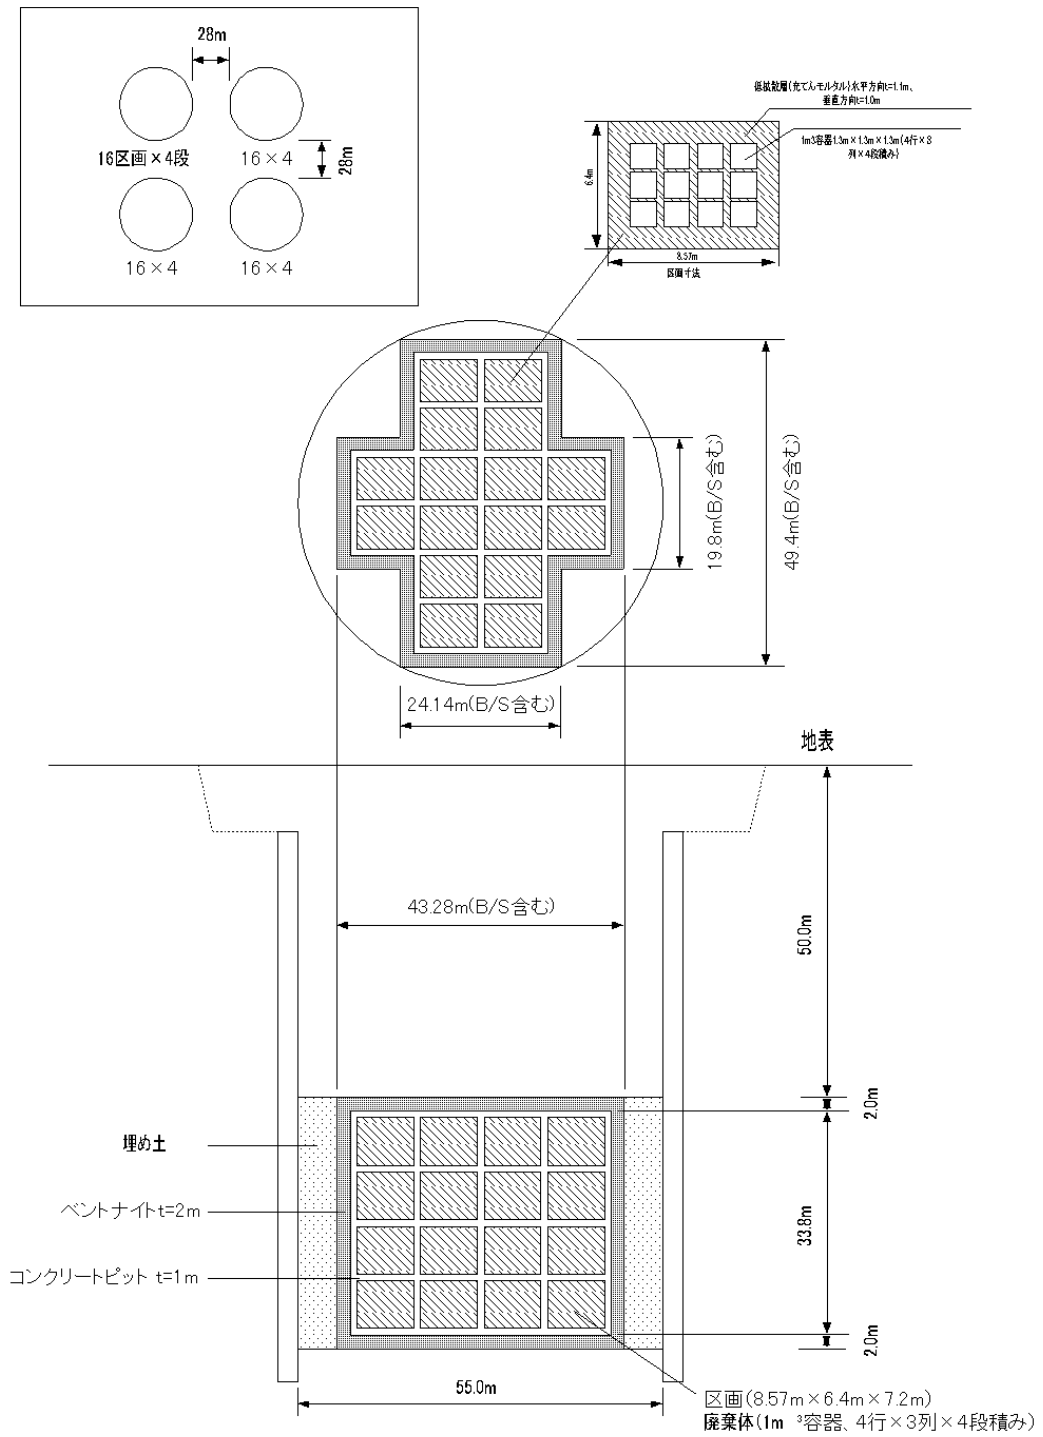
ケース2(増設)の開削サイロ型施設配置図
